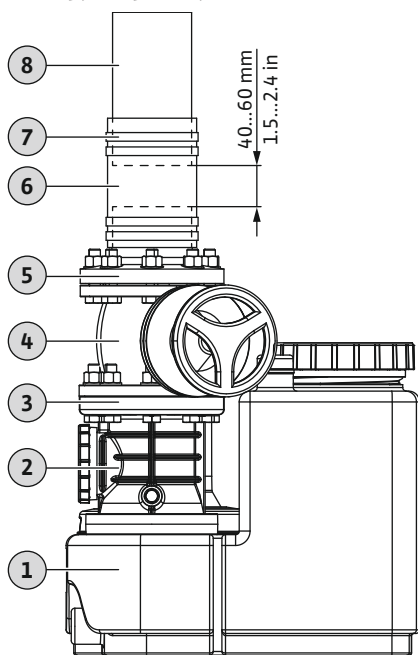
Монтаж під'єднання до напірного трубопроводу
